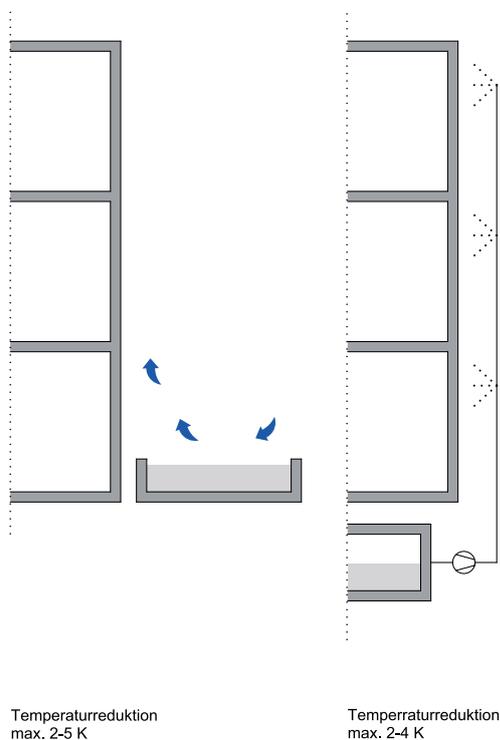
Verdunstungskühlung durch Wasserflächen in Fassadennähe/durch besprühen der Fassade mit Wasser
